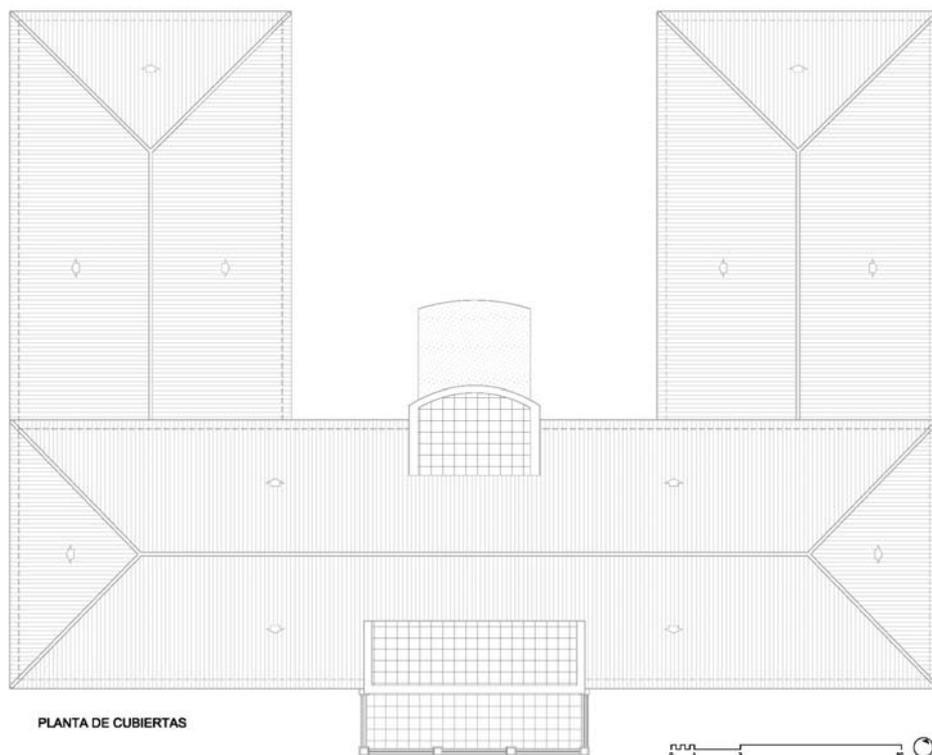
Planta de cubiertas del palacio. Orenes García, Matías J., 2015.
